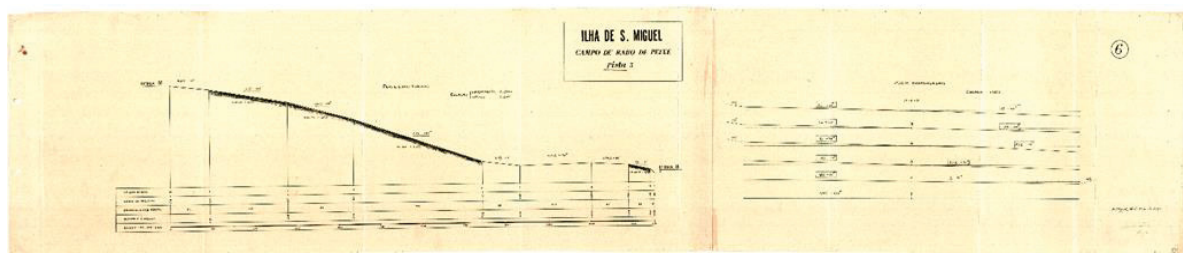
Projeto de prolongamento da pista 3 perfil longitudinal e perfis transversais
